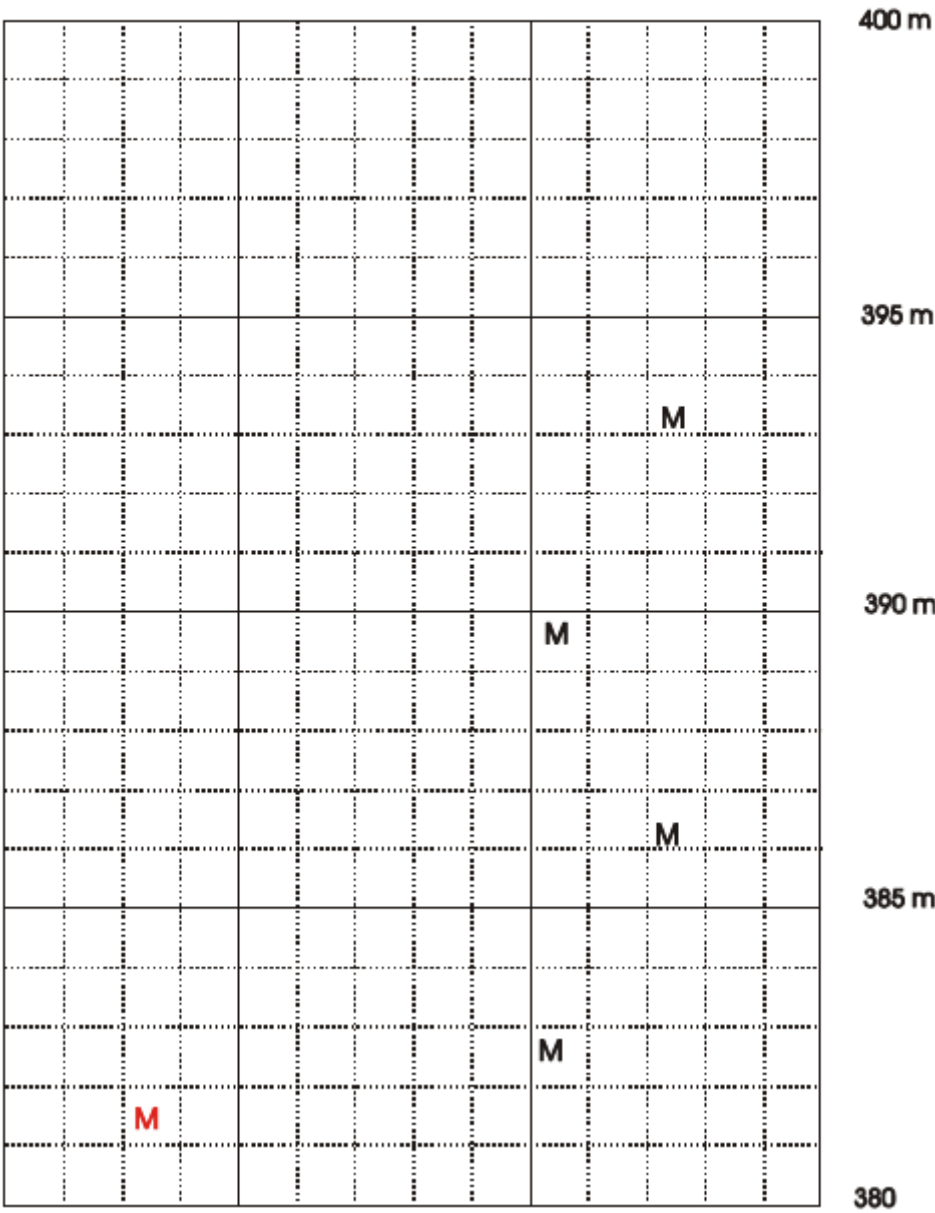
Planche de fissuration travée Sud-Ouest Zone 2
